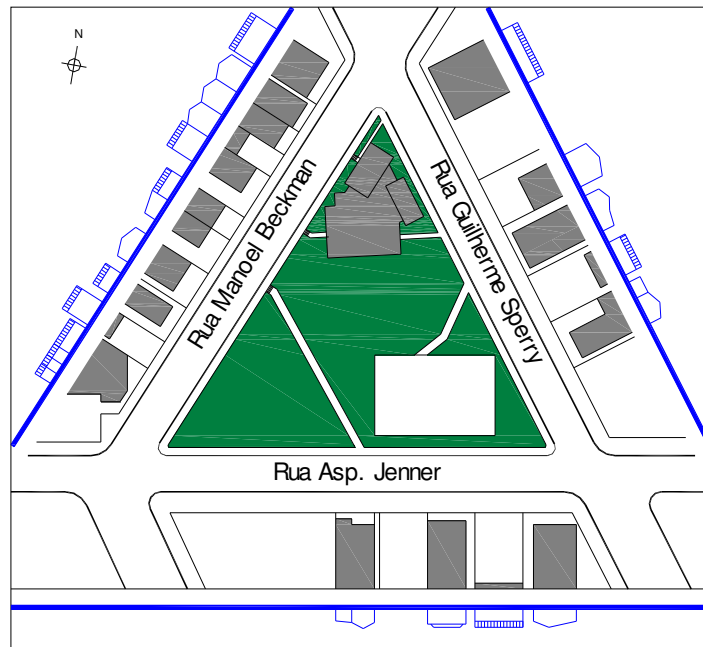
Planta Baixa da Praça São Francisco e entorno.
